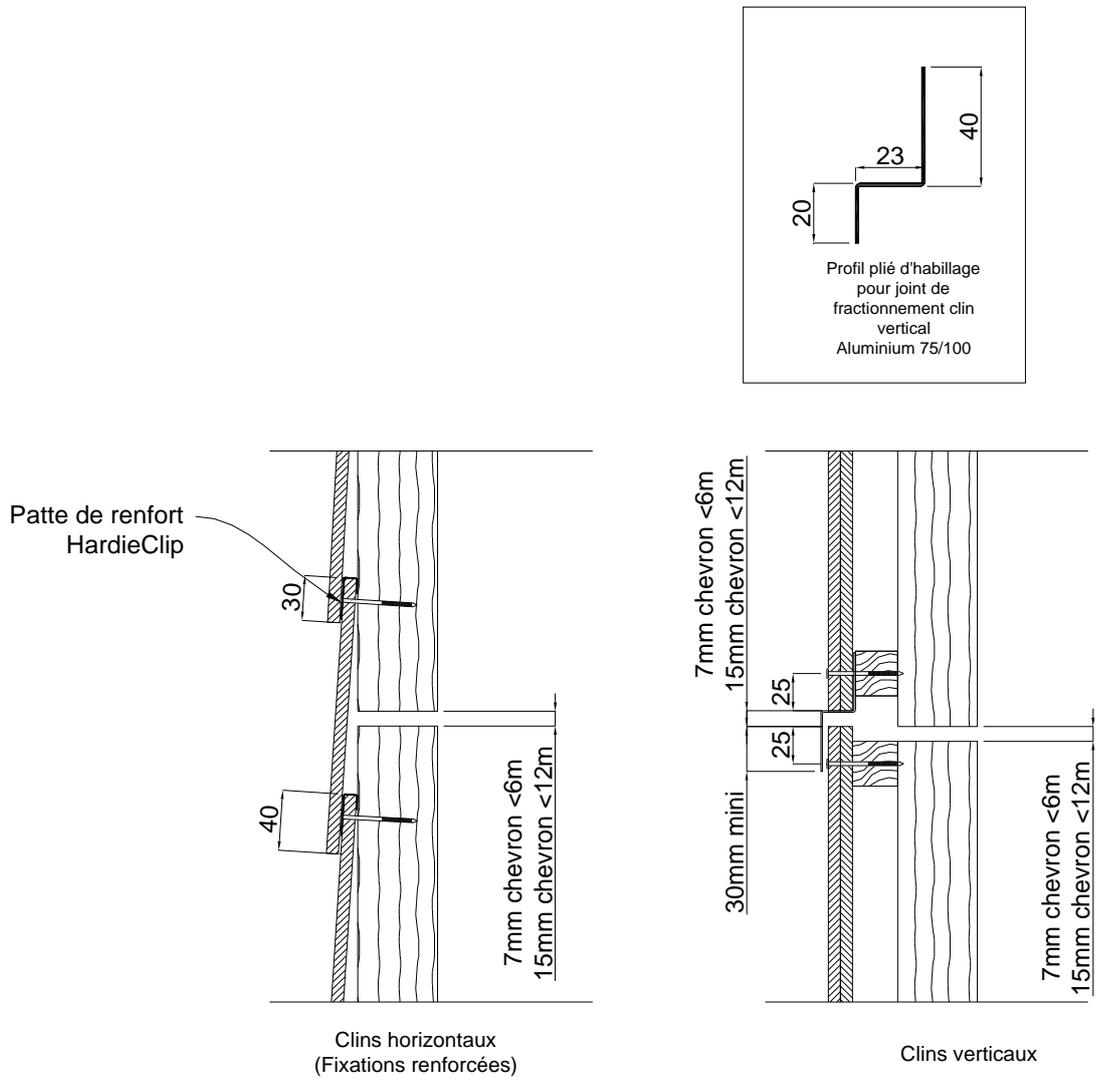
Coupe verticale sur joint de fractionnement – ossature bois
